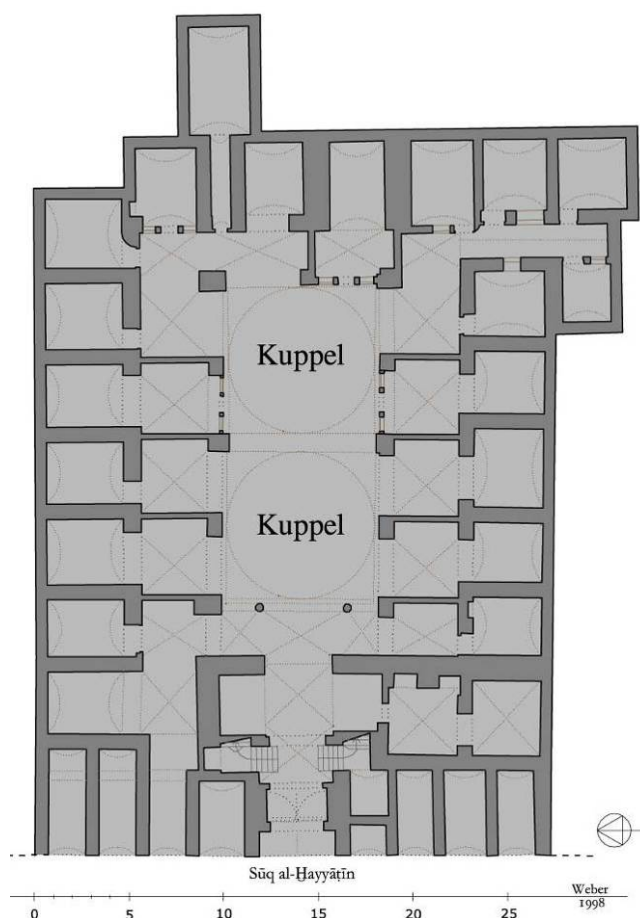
Ḥān al-Ġūḥīya, Grundriss EG
